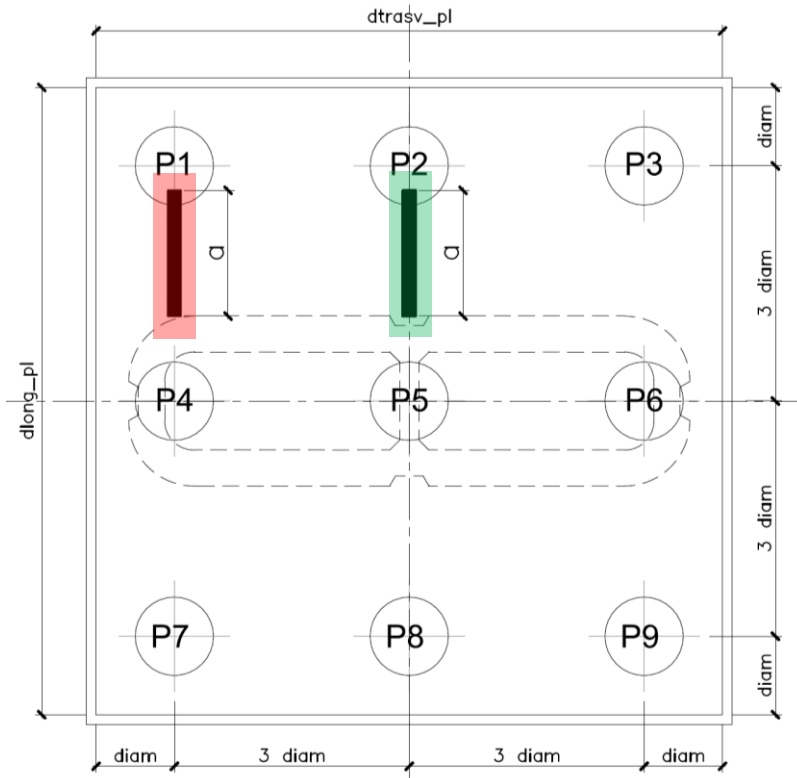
Vista in pianta - Tirante-puntone centrale (verde) e di spigolo (rosso)
